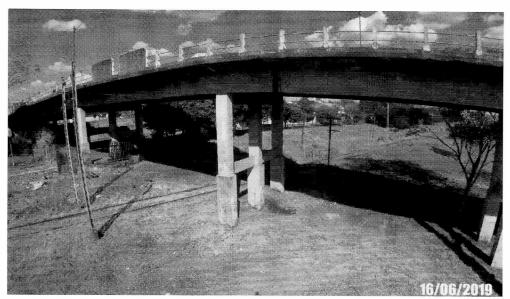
Vista da face lateral da viga com infiltração, eflorescência e desplacamento de concreto.
